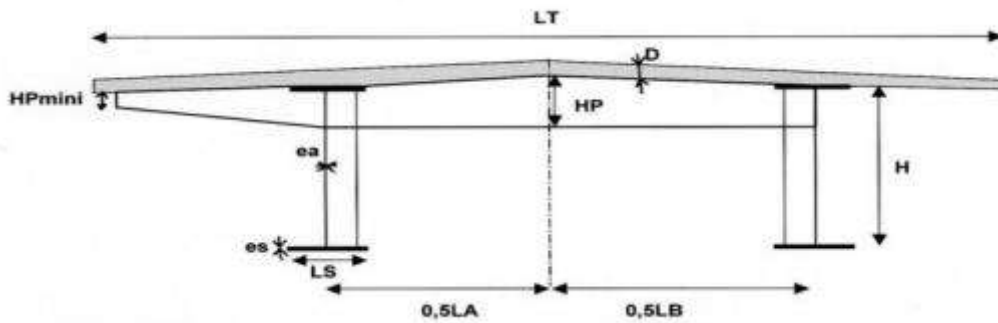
Paramètres du dimensionnement d'un bipoutre à pièces de pont
